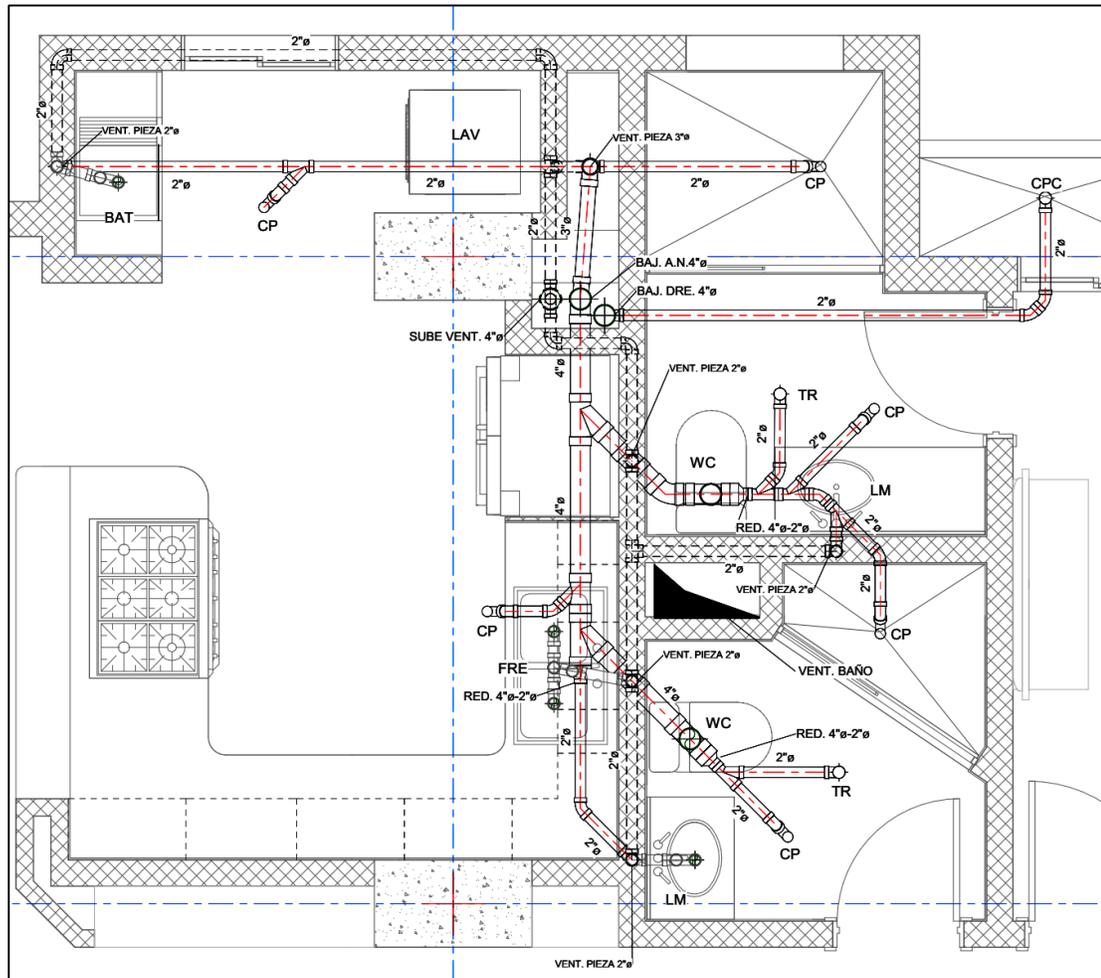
Red de A.N. en planta típica (PA) de la Torre Shinon.
